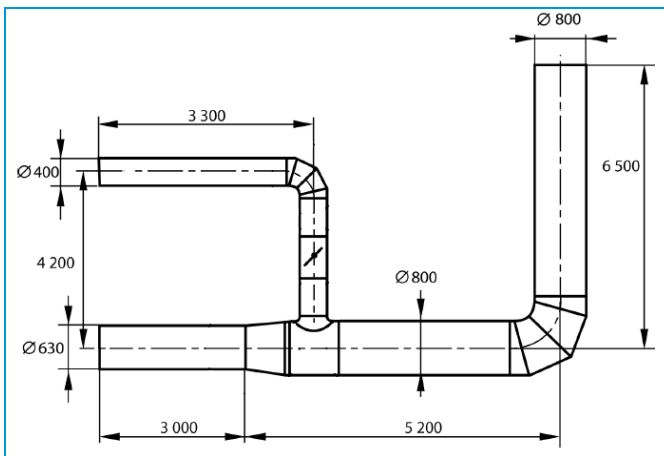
Exemple d'une installation type de réseau de conduits circulaires
